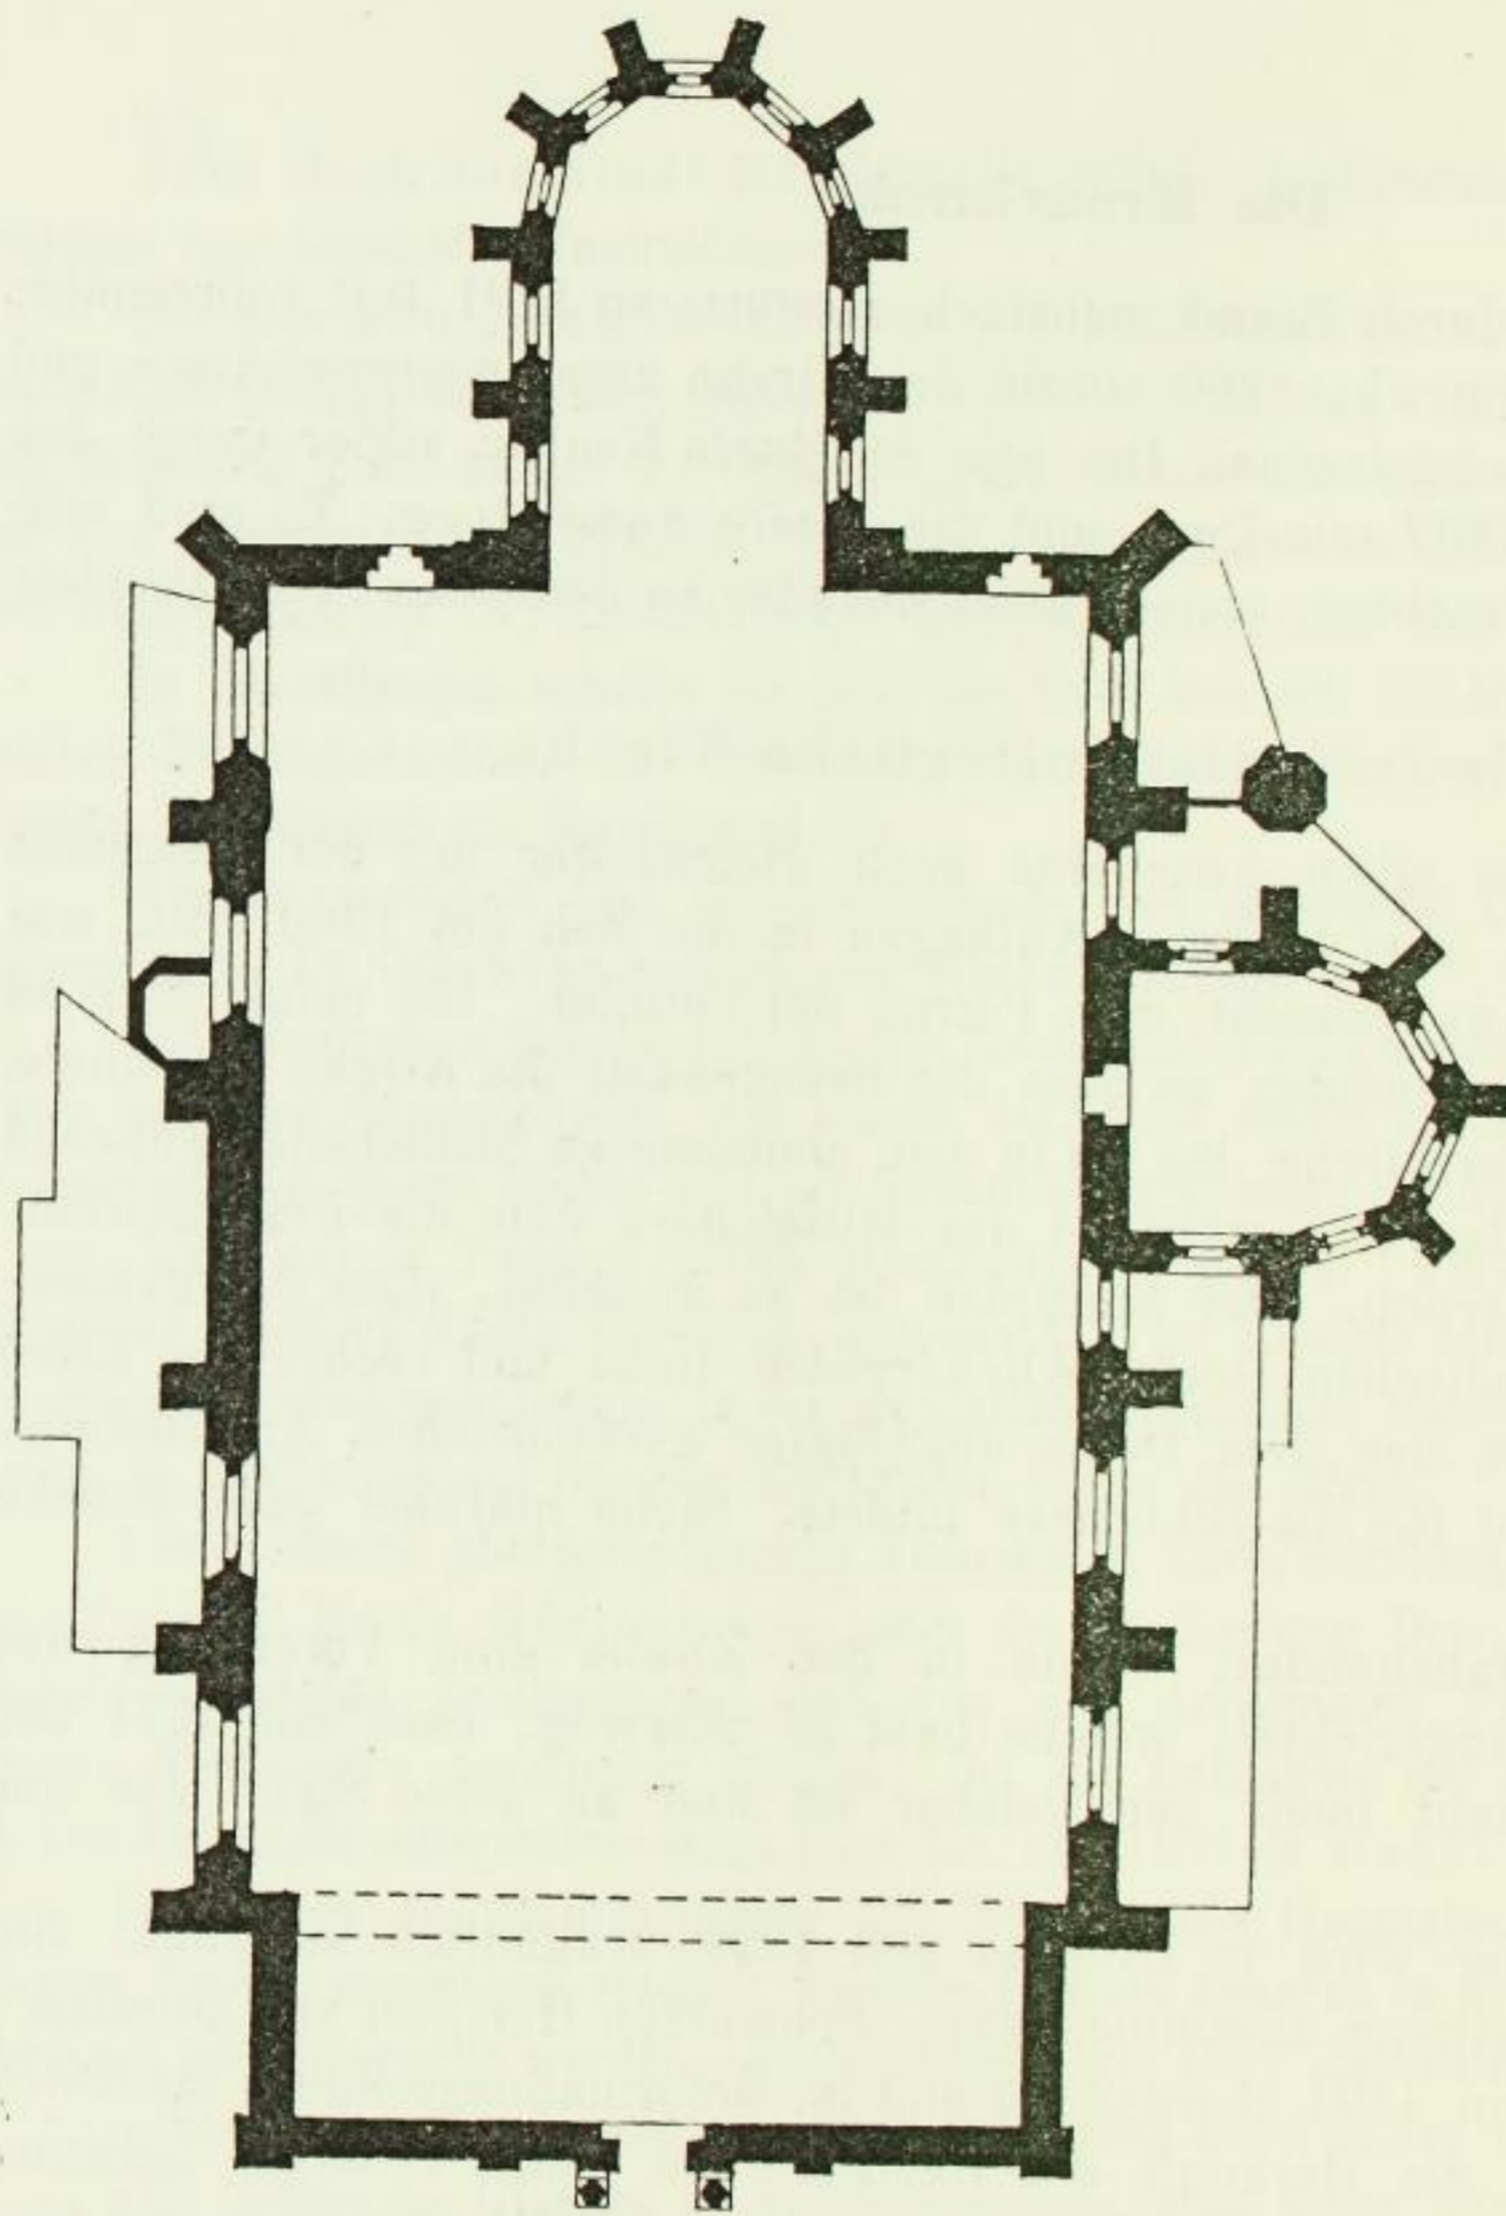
Grundriss der Kreuzkirche. 18. Jahrh. Nach einem Plane in der Sammlung König Friedrich August II.
